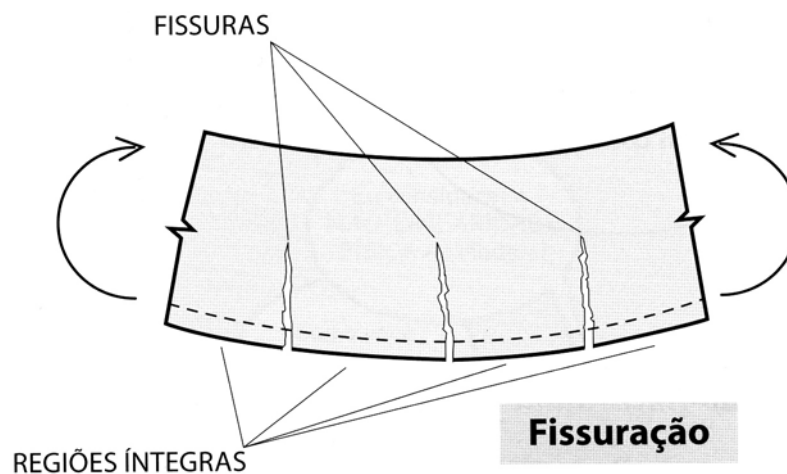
Elemento fissurado (KIMURA, 2007).
